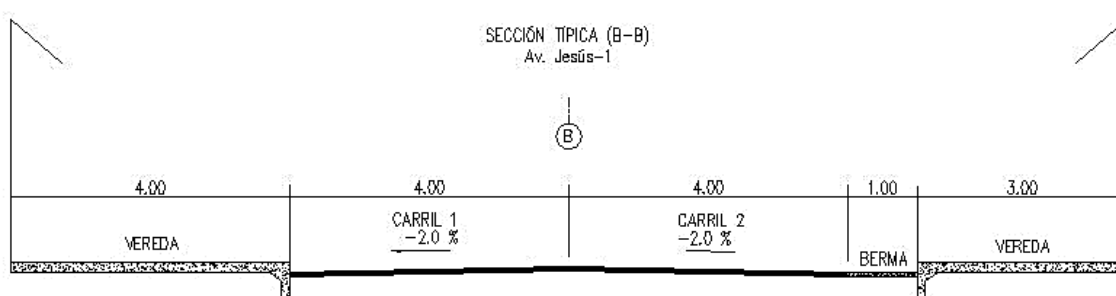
Sección Transversal de la Av. Jesús corte B-B
